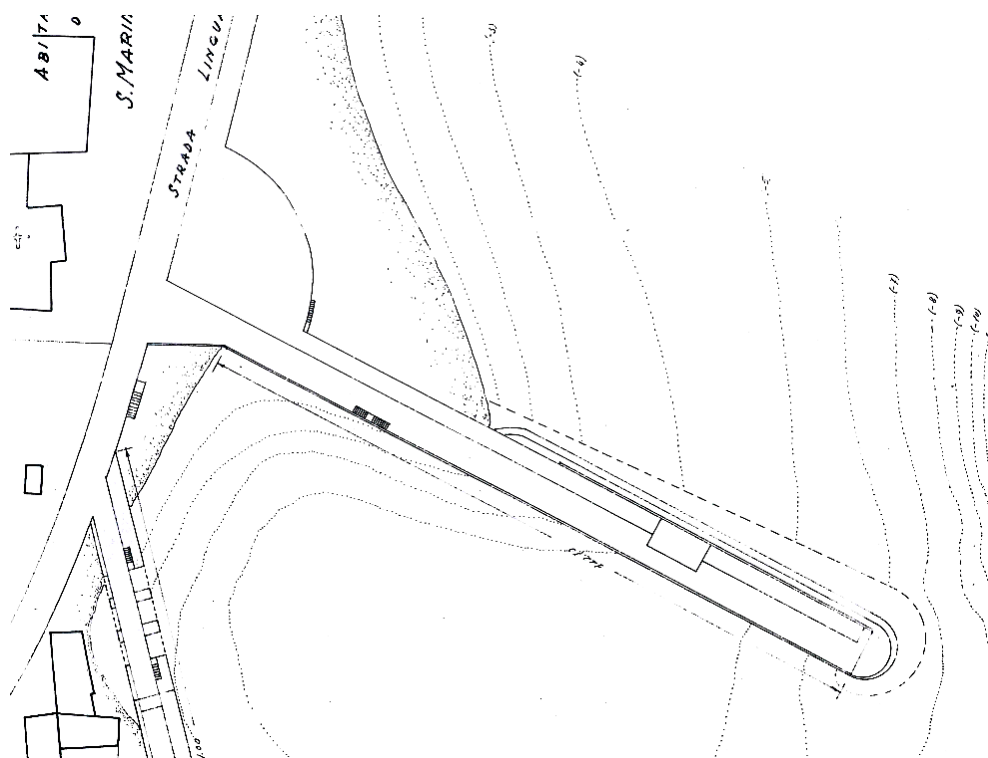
Planimetria del molo di mezzogiorno – Progetto 1966
